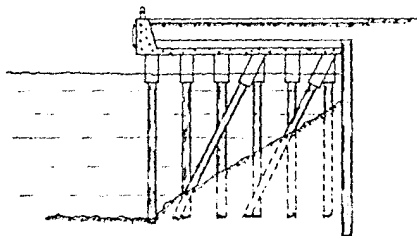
Construcción tipo abierto con plataforma de recepción.
